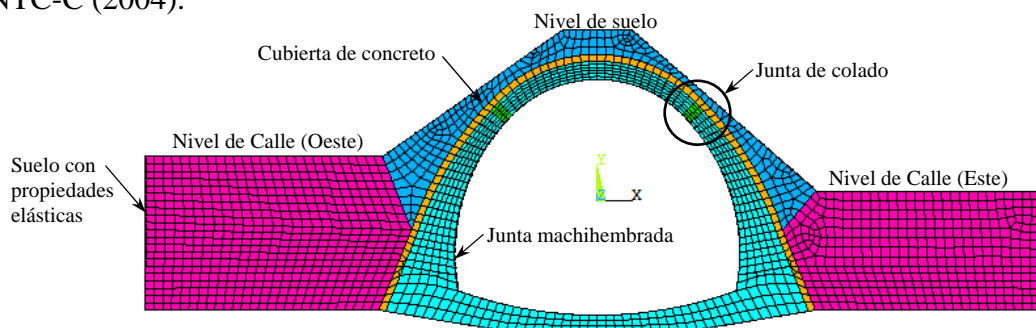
Modelo de elementos finitos para el refuerzo con cubierta de concreto reforzado
